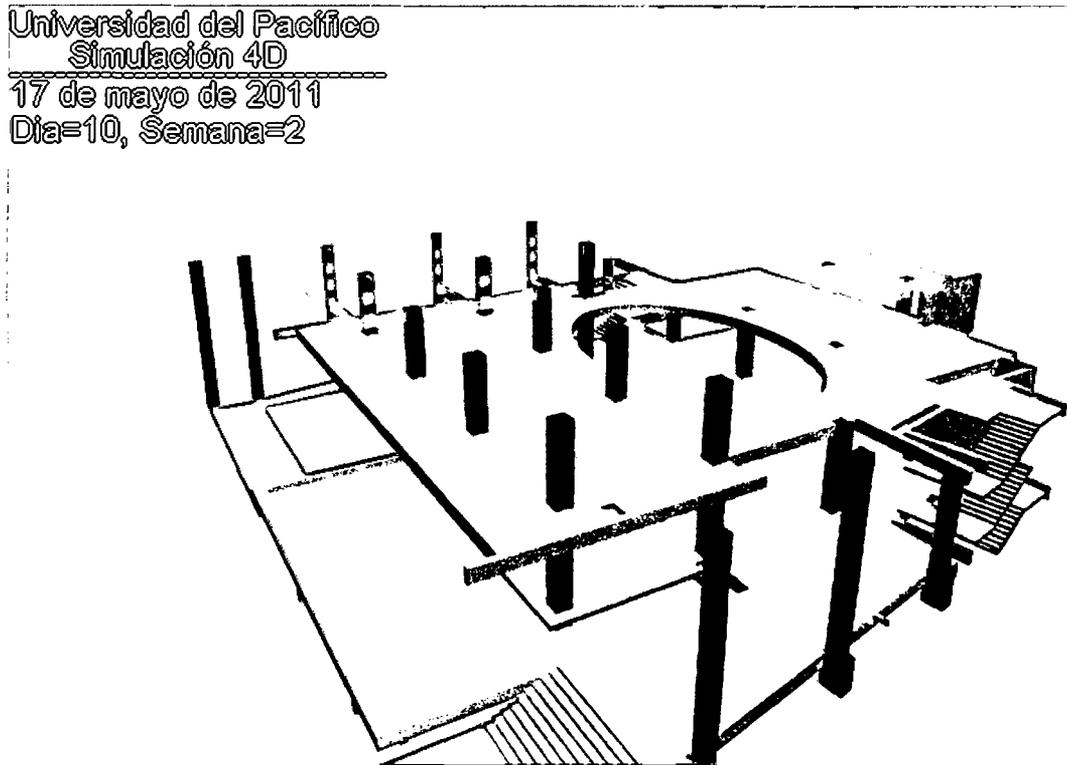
Simulación del proceso constructivo de la estructura de concreto
